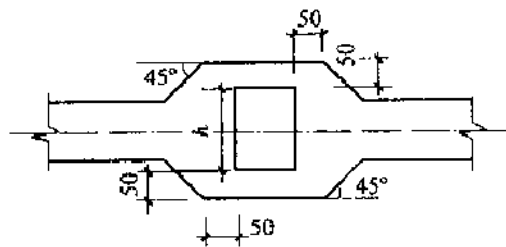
现浇柱与条形基础梁的交接处平面尺寸
